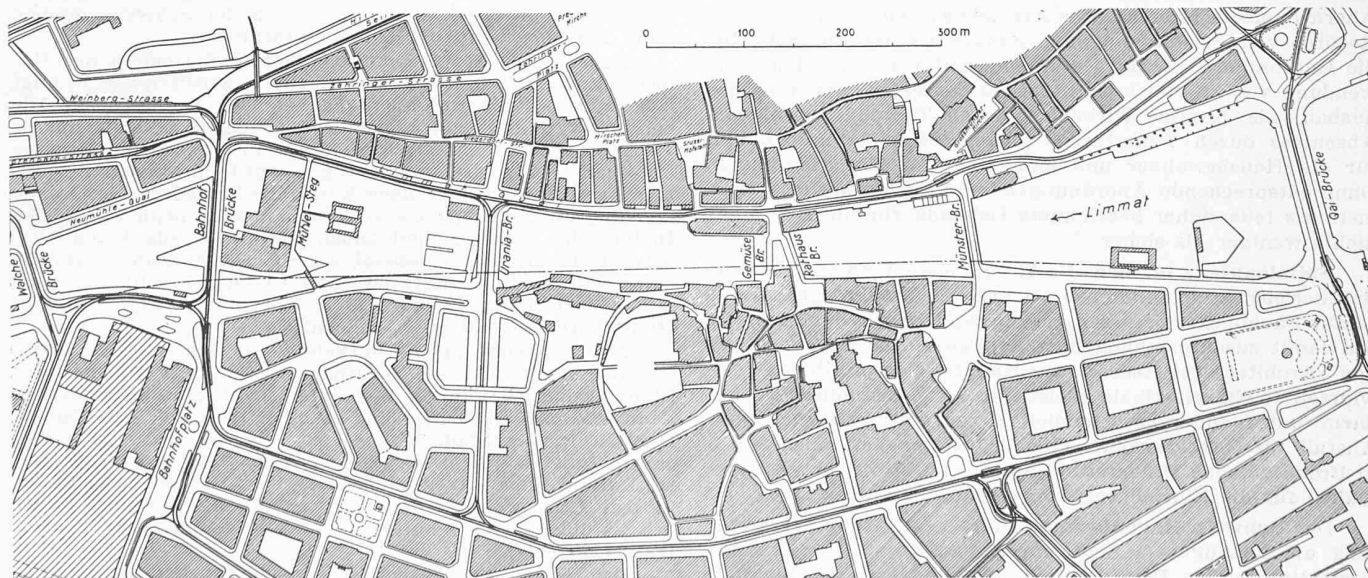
Zürichs Innenstadt mit ungefähre Lage der Axe des von Ing. S. ZIPKES vorgeschlagenen Autotunnels. Masstab 1:7500
